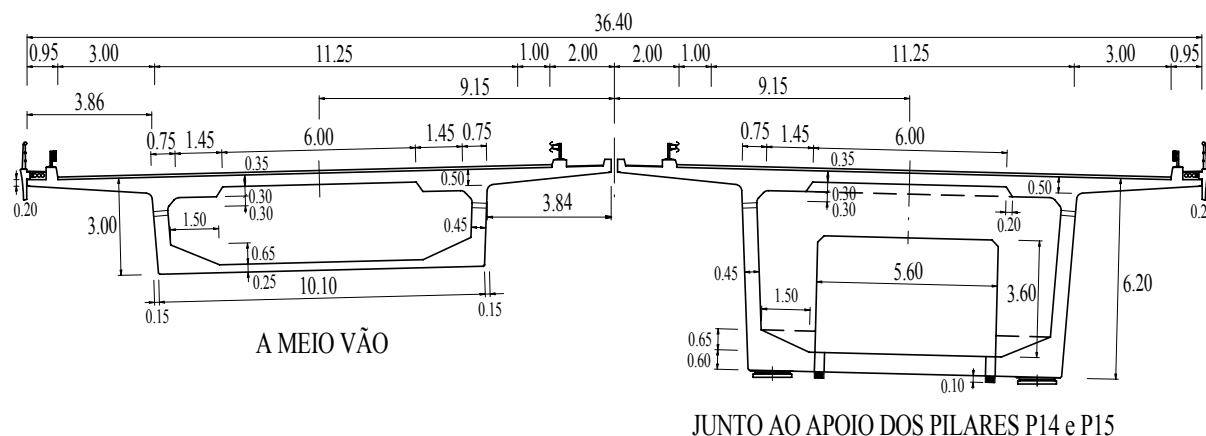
Secções transversais do tabuleiro da Ponte sobre o Rio Lis.
